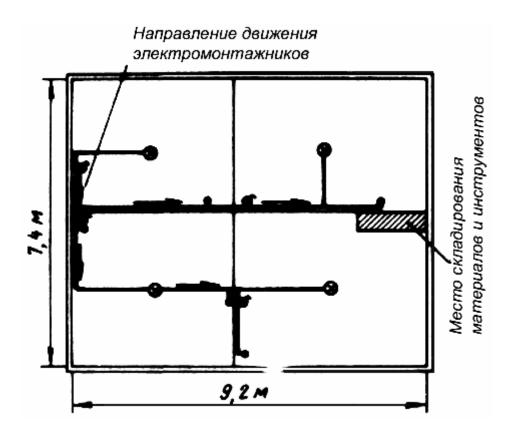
Схема организации рабочего места при монтаже открытой электропроводки.
